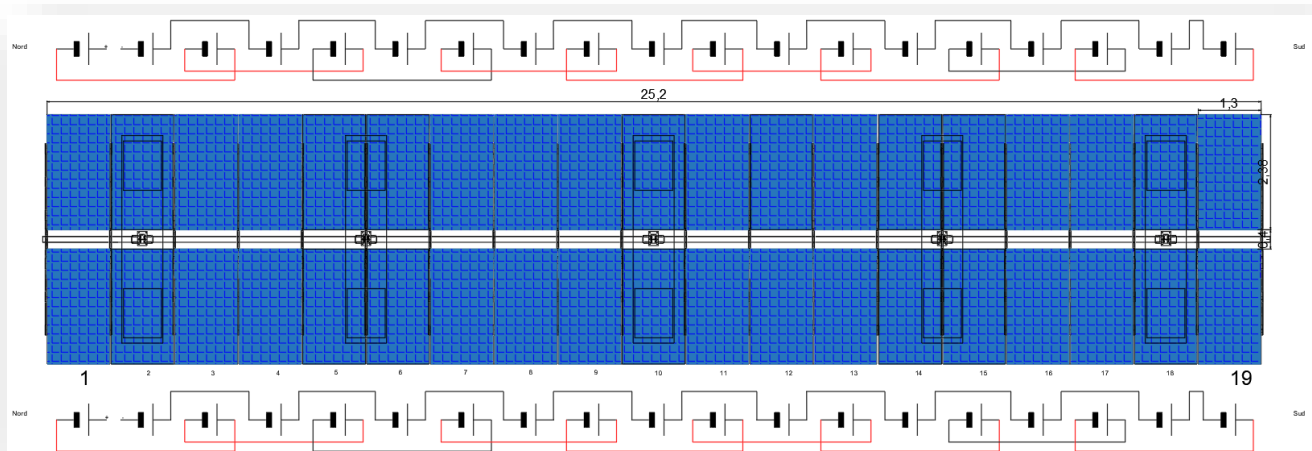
vista dall'alto Tracker/Modulo/schema di connessione
